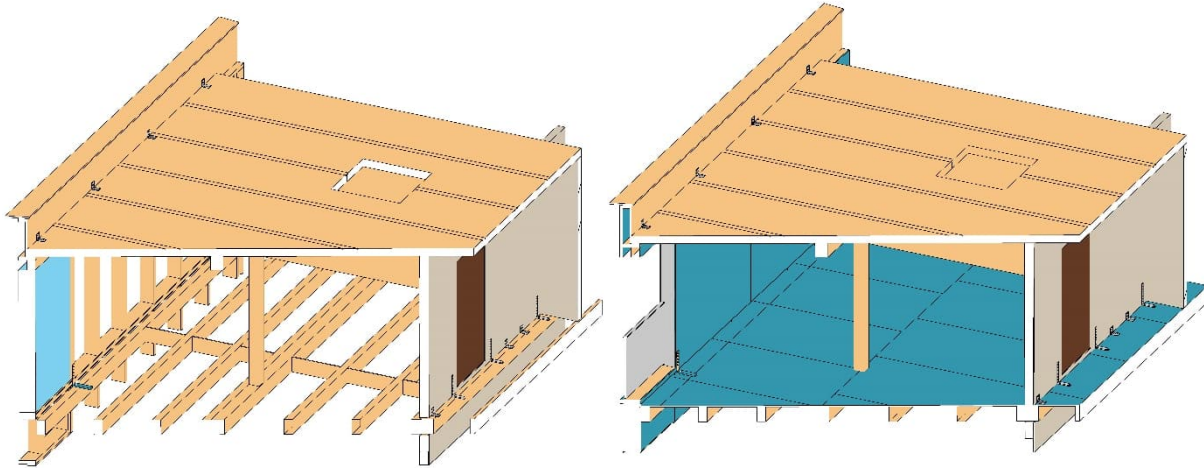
Modelle „Werkstattplanung“ Holzbauunternehmen ohne Beplankung und mit Beplankung
